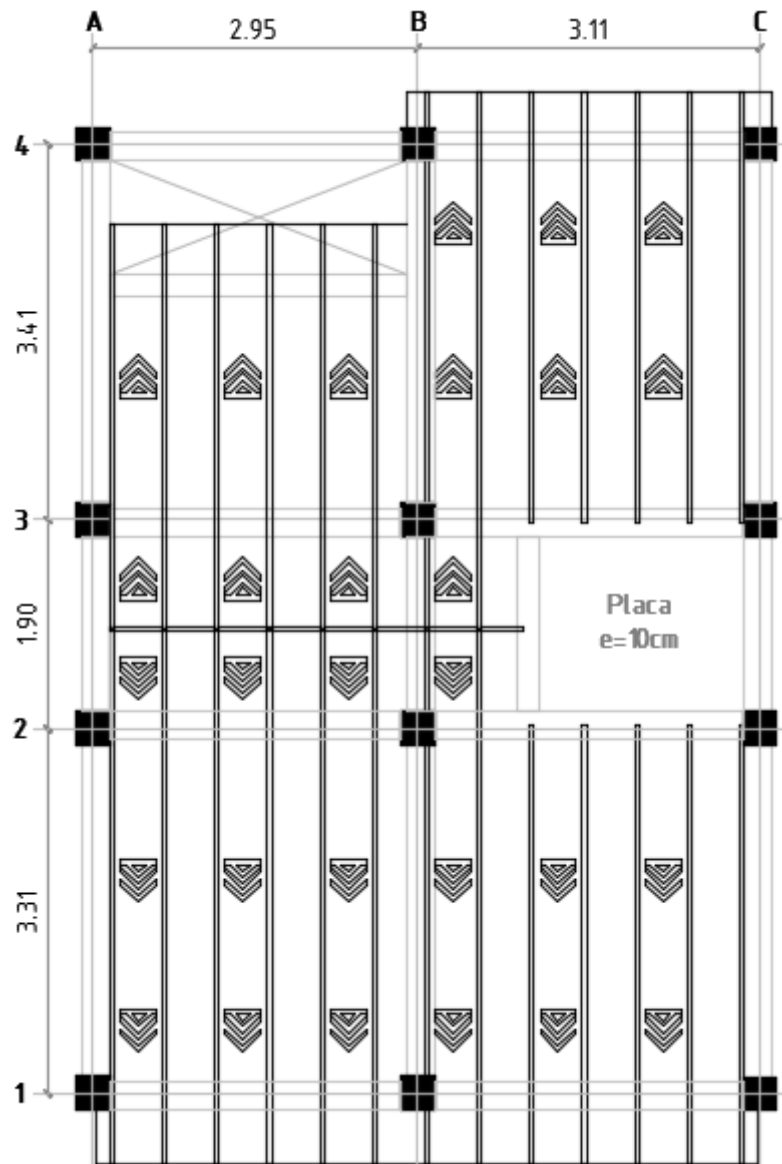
Detalle de cofiguración en planta de cubierta liviana
